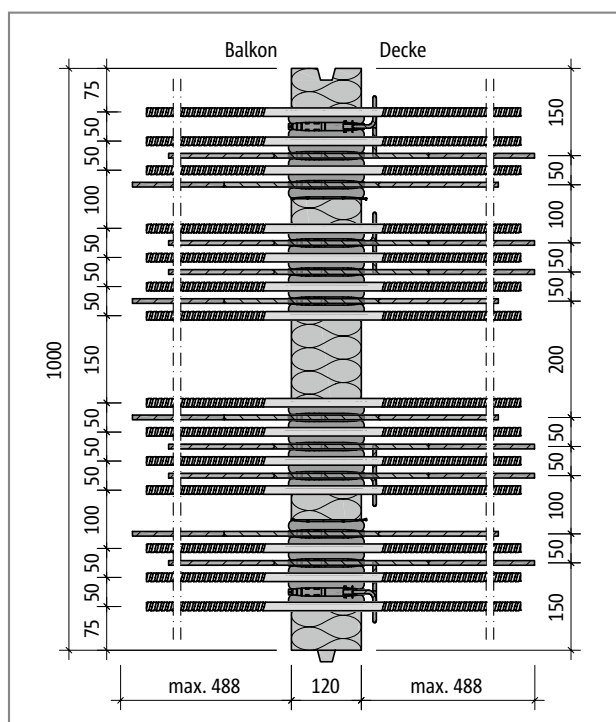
Schöck Isokorb® CXT Typ K-M7-VV1: Produktgrundriss
